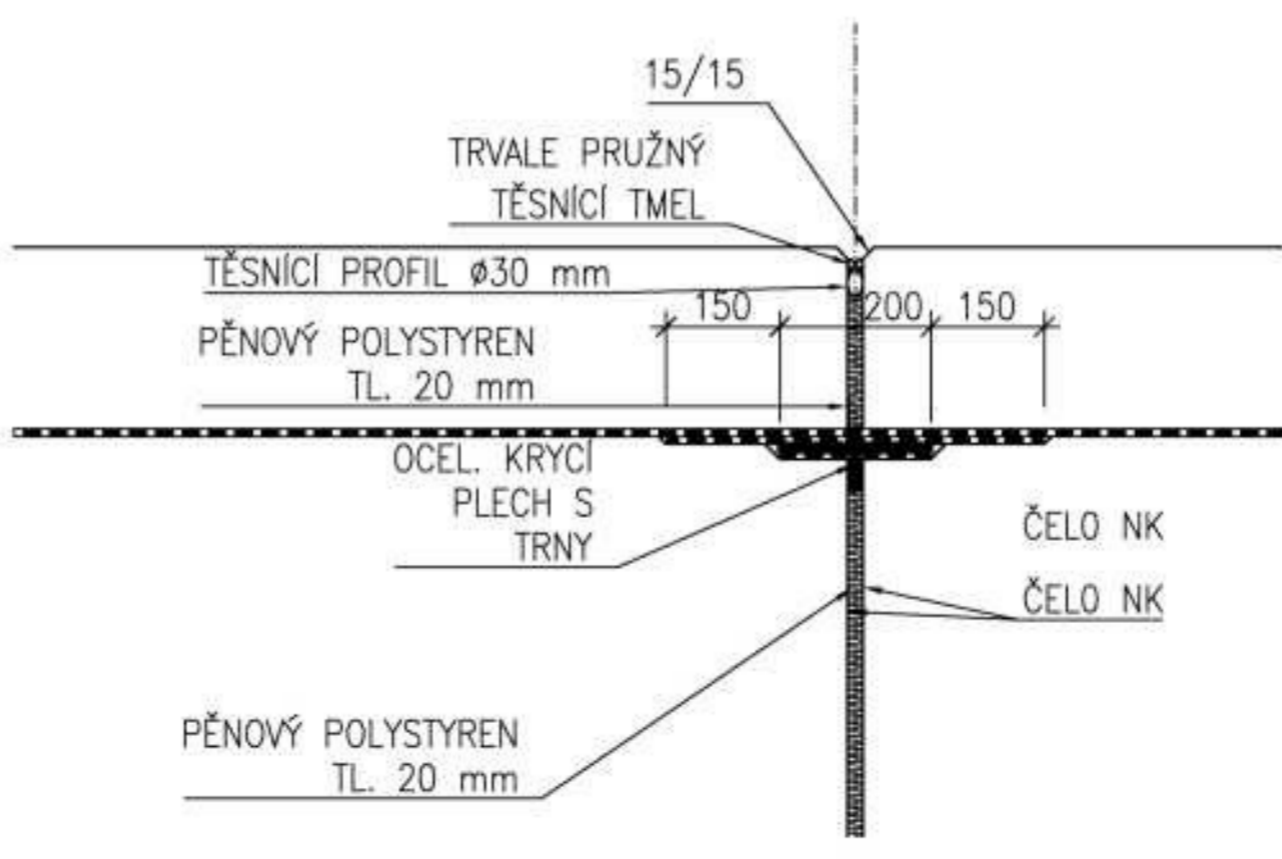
DETAIL VYBRÁNÍ DILATAČNÍ SPÁRY
